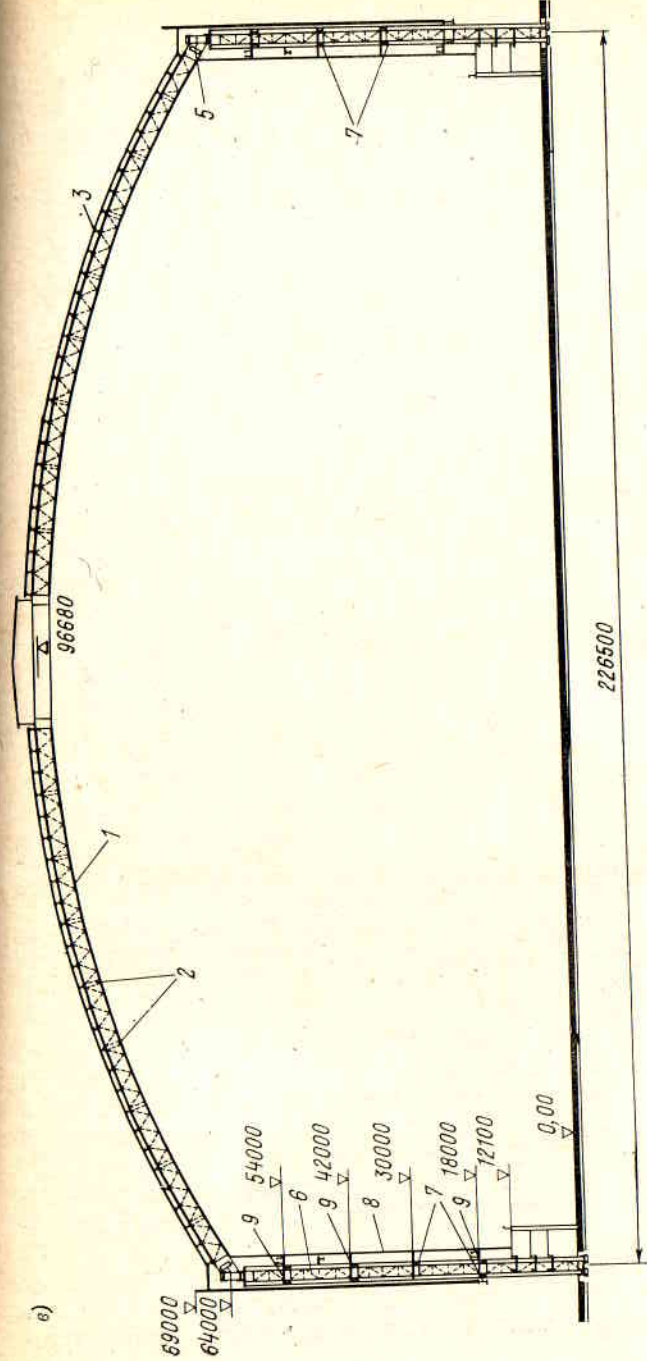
Купольное покрытие над зданием высоковольтного испытательного центра
